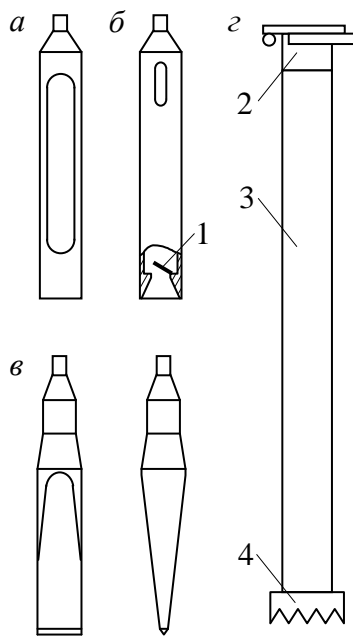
Інструмент для ударно-канатного буріння: а – забивний стакан; б – желонка; в – долото; г – обсадна труба; 1 – клапан; 2 – наголовник; 3 – ланка обсадної труби; 4 – фреза
